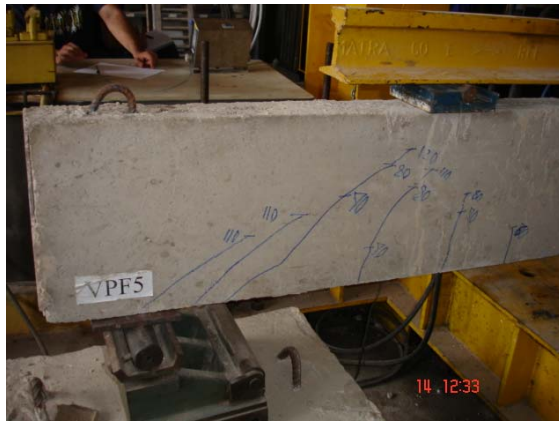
Padrão de fissuração da viga VPF5 (ruína por cisalhamento)
